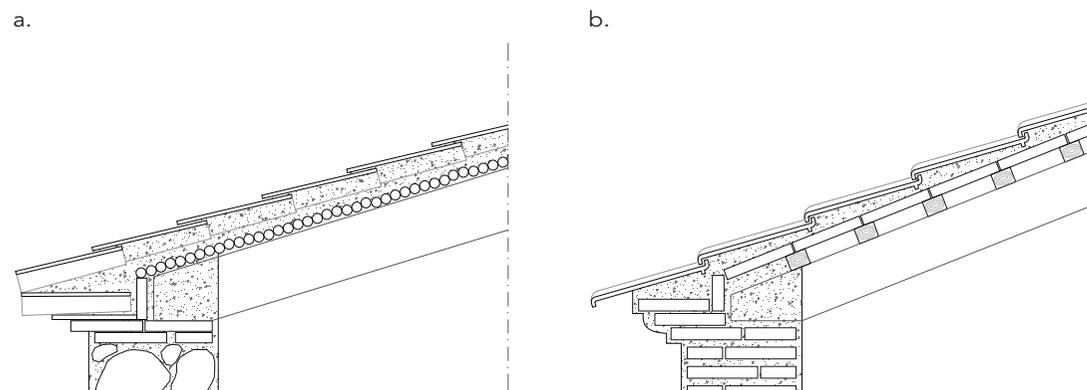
Detalles constructivos estructura de cubiertas, a.cubierta inclinada de viguetas y cañizo; b.cubierta inclinada de viguetas con entablicado de rasilla.
